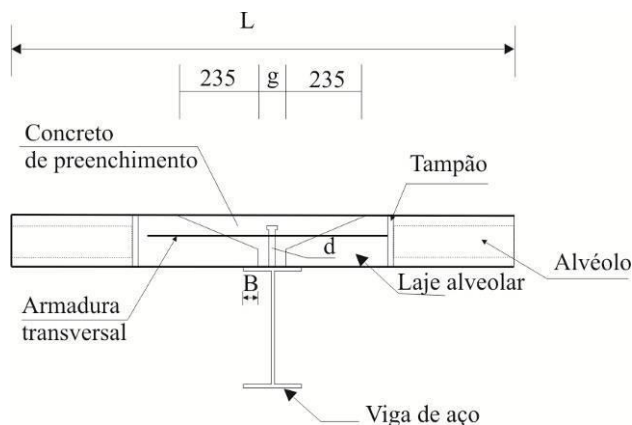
Seção transversal do modelo de viga mista estudada por [4]
